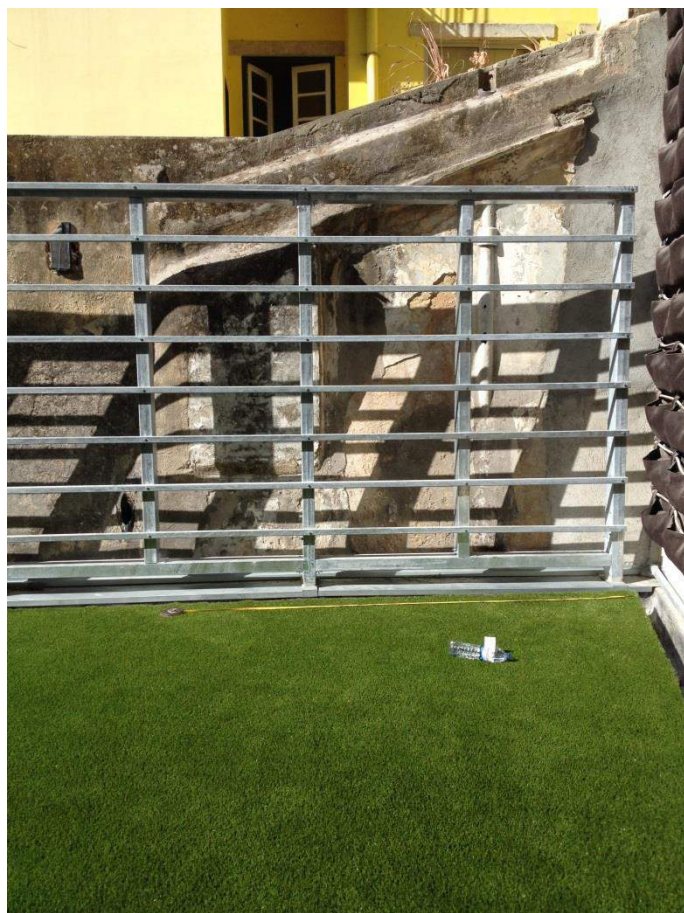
Fase 1 e 3 da construção da parede viva do Bessa Hotel Av. Da Liberdade(Fevereiro de 2014)
